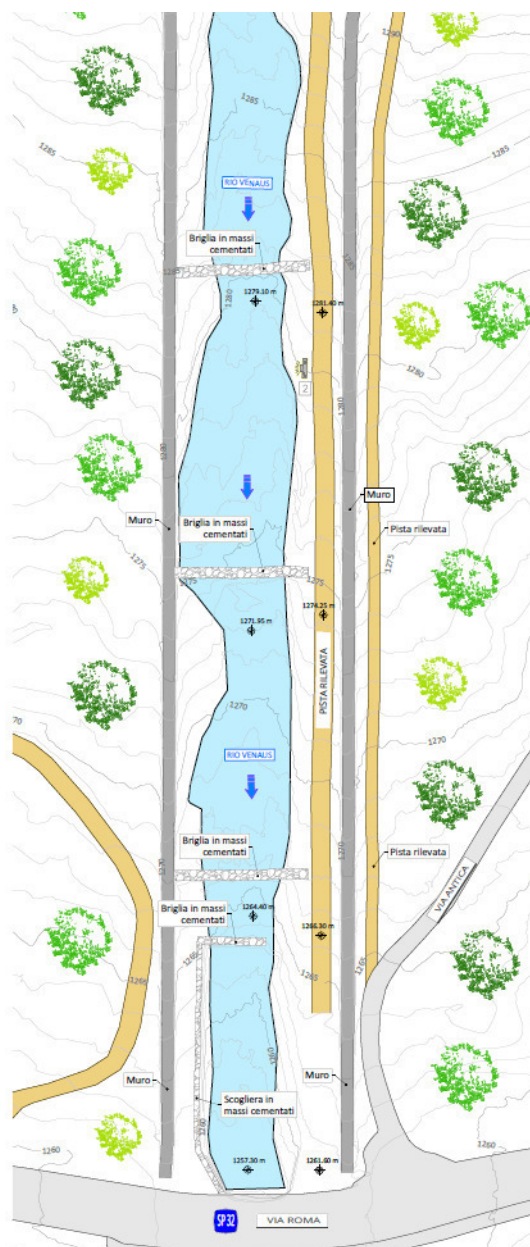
Estratto della tavola 4.2 - Planimetria di rilievo Intervento 2
